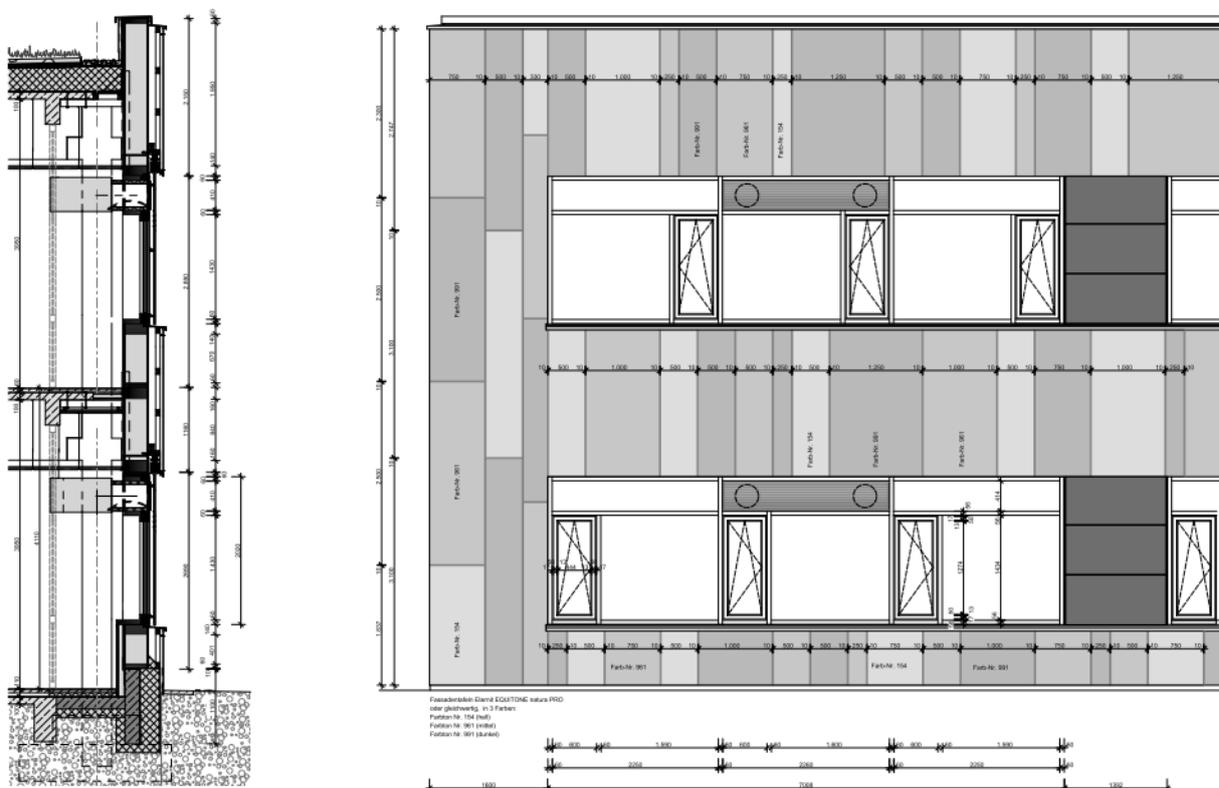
Fassadenschnitt (mit alter Fensterfassade) und Ansicht (Teilausschnitt)
